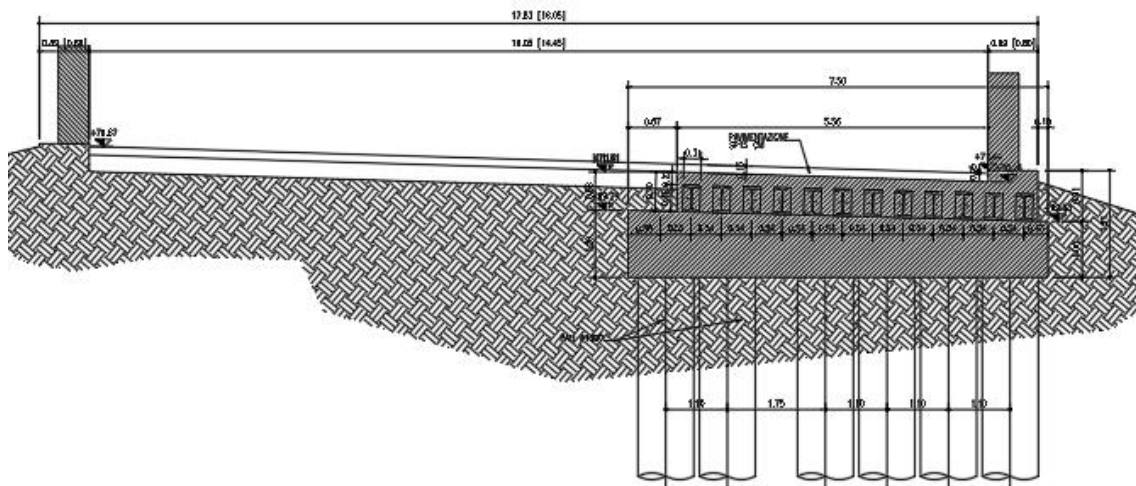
Sezione trasversale dell'impalcato - Lato Genova
